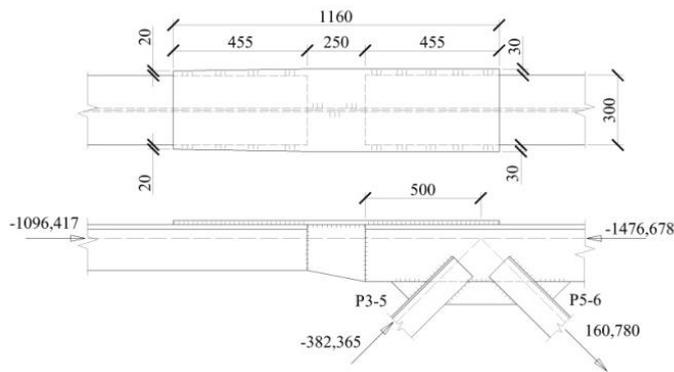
Розрахункова схема вузла поєднання поясів ферми.
